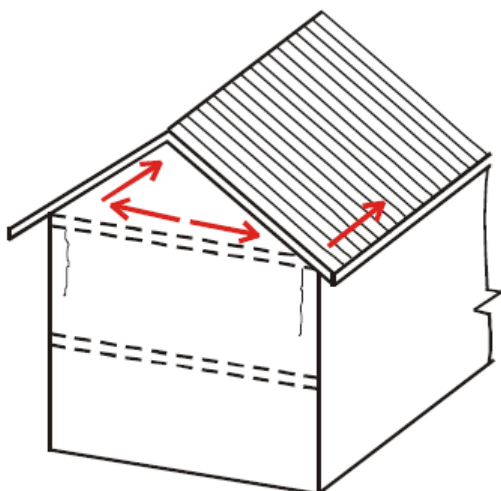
Fissura na base da parede por expansão da laje e retração da alvenaria. extremidade do prédio
